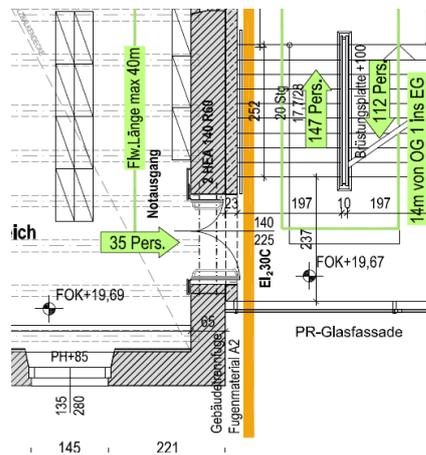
Planausschnitt Bestandsplan S0132_1
